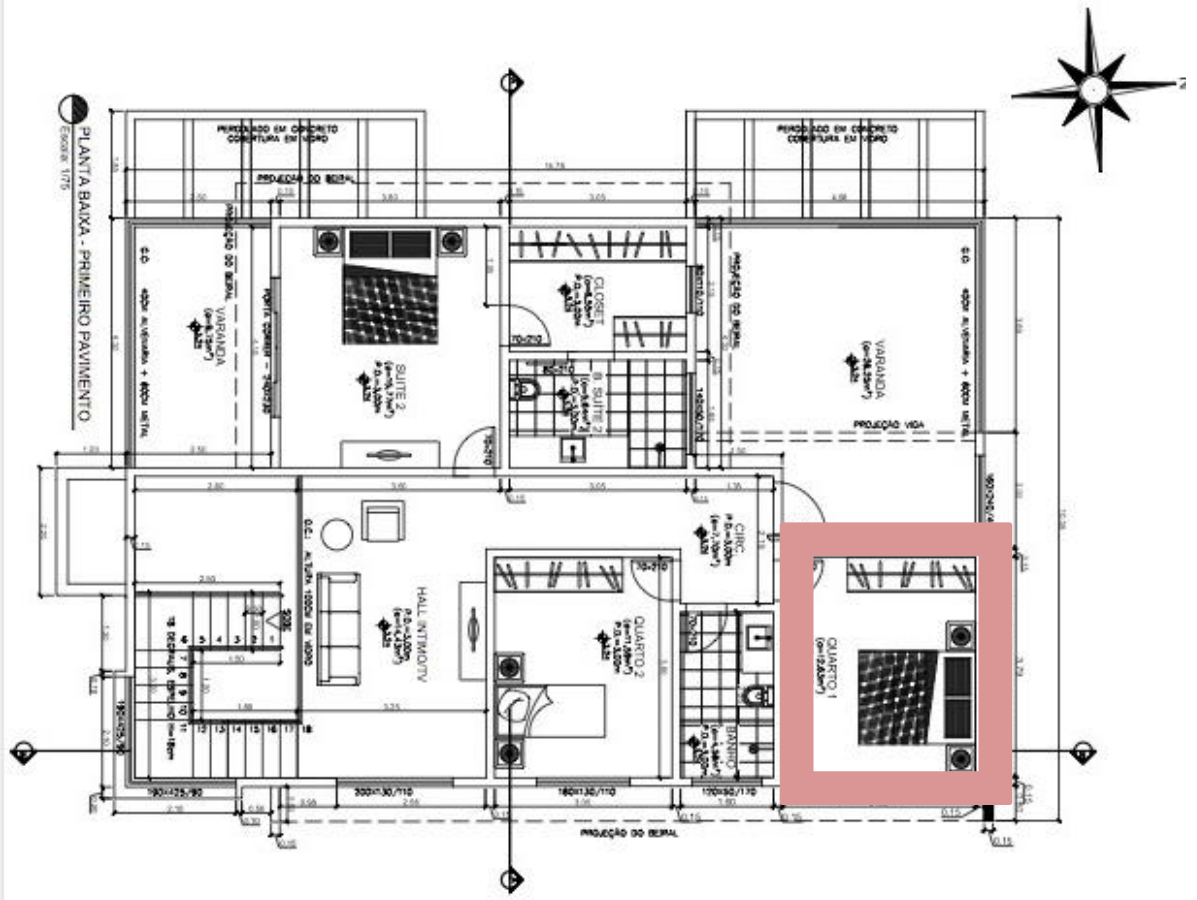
planta baixa primeiro pavimento do Modelo estudado
